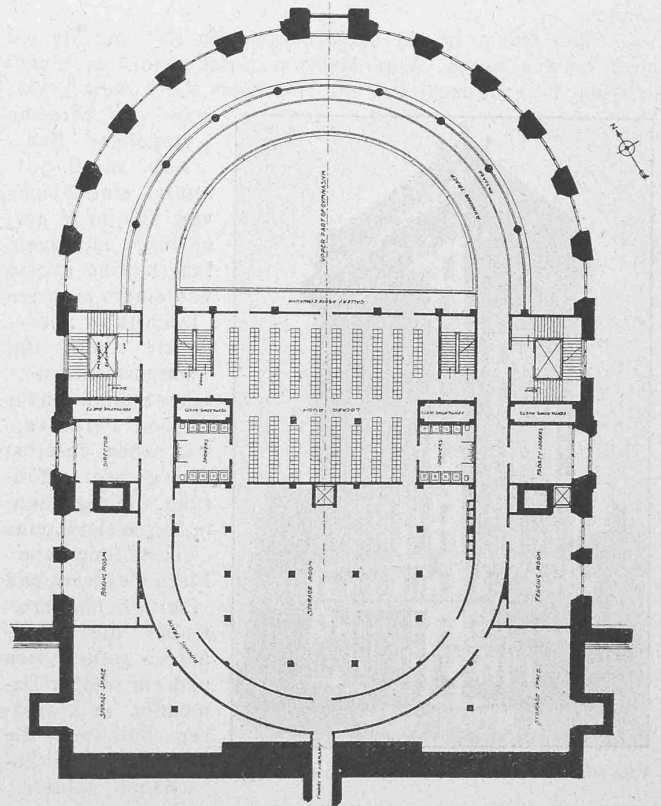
Columbia University. — Turnhalle. Grundriss vom Obergeschoss mit Rennbahn. 1 : 700.
